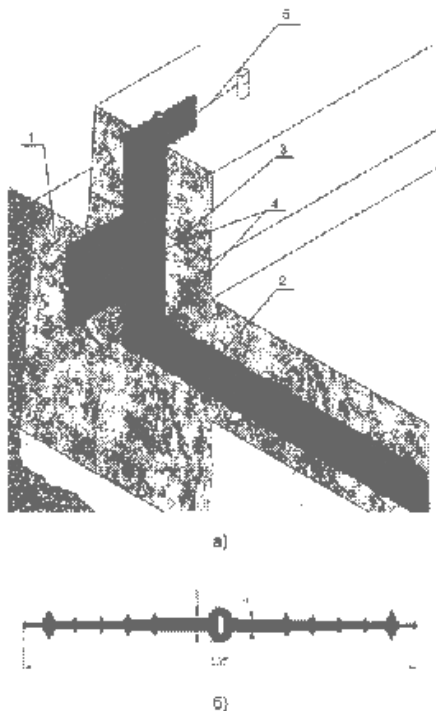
Универсальная гидротехническая шпонка ТХЗ-1. а – схема расположения шпонки «в теле» бетона; б – сечение шпонки, основные размеры. 1 – бетонная конструкция; 2 – гидротехническая шпонка ТХЗ-1; 3 – водонабухающая уплотнительная прокладка; 4 – фасонные элементы шпонок; 5 – крепление шпонки к арматуре.
